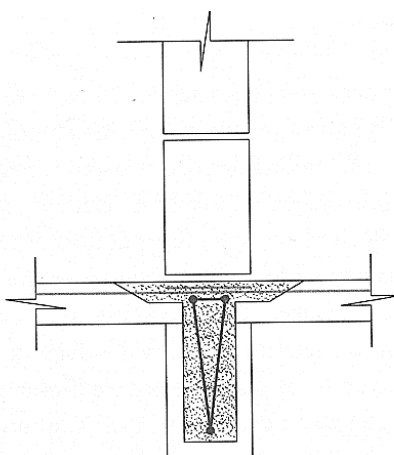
Opção para detalhe contra colapso progressivo em painéis de lajes pré-moldadas com ligação entre estes (a armadura negativa deve ser maior que $1,5 \text{ cm}^2/\text{m}$). Fonte: Parsekian (2012).
